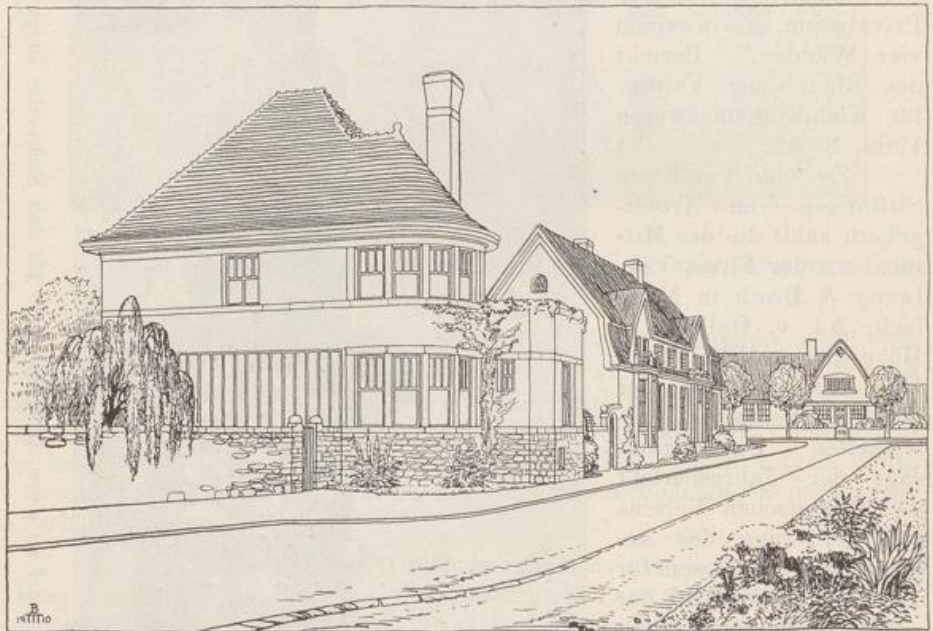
Beamtenwohnhauskolonie Gutehoffnungshütte, Oberhausen.
